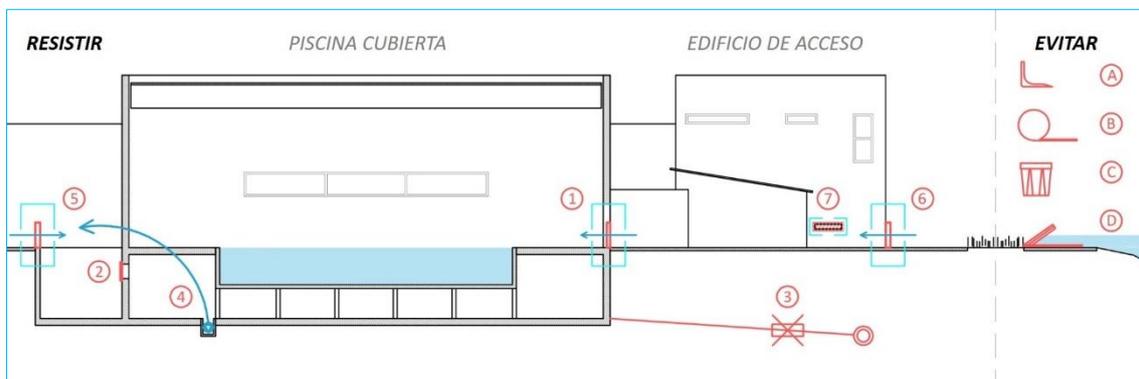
Complejo Adarraga, propuestas de adaptación: RESISTIR (1 Barreras en los accesos, 2 Sellado puntual, 3 Válvula antirretorno, 4 Bomba de achique, 5 Murete, 6 Antepecho, 7 Sellado permanente) o EVITAR (A Boxwall, B Tubewall, C Boxbarrier, D Velox).
